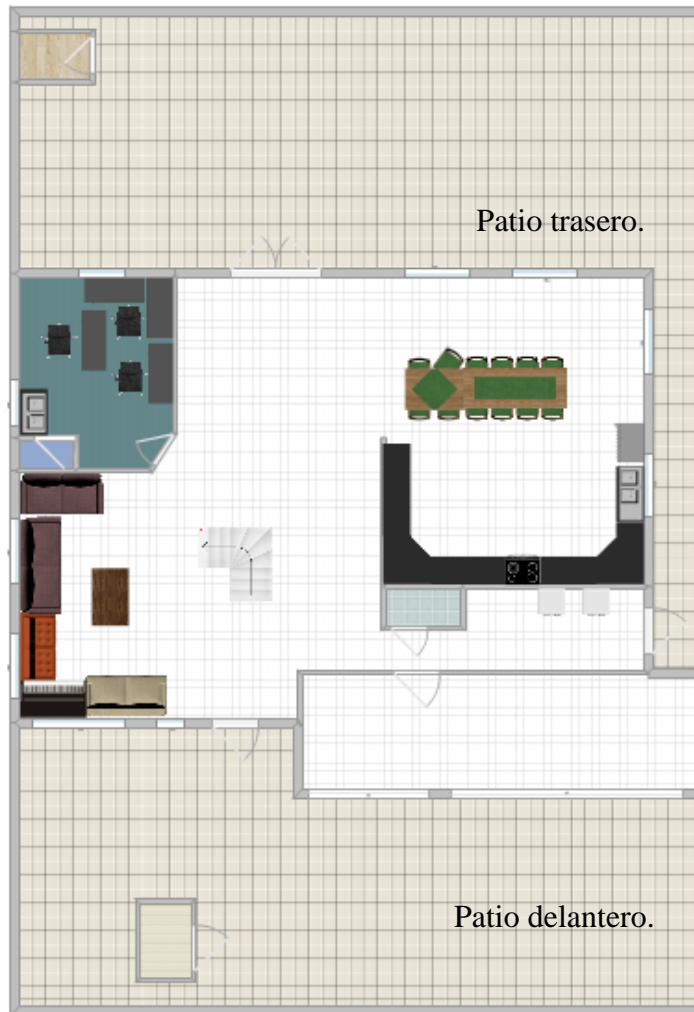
plano de la primera planta de la Casa del Jardín.⁹⁶
